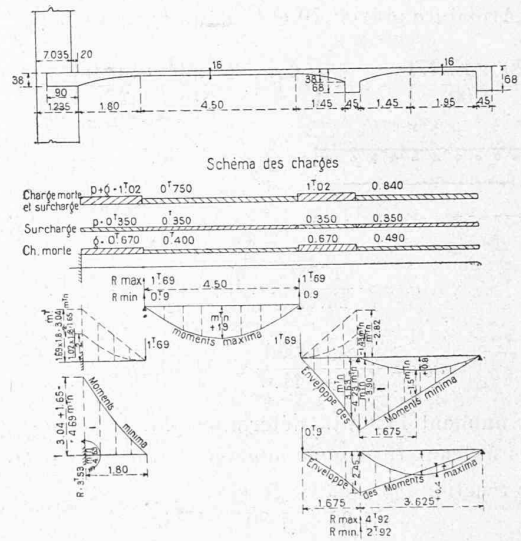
Poutraison sur rez-de-chaussée. — Coupe C-D. Epures. — Surcharges : 350 kg.
